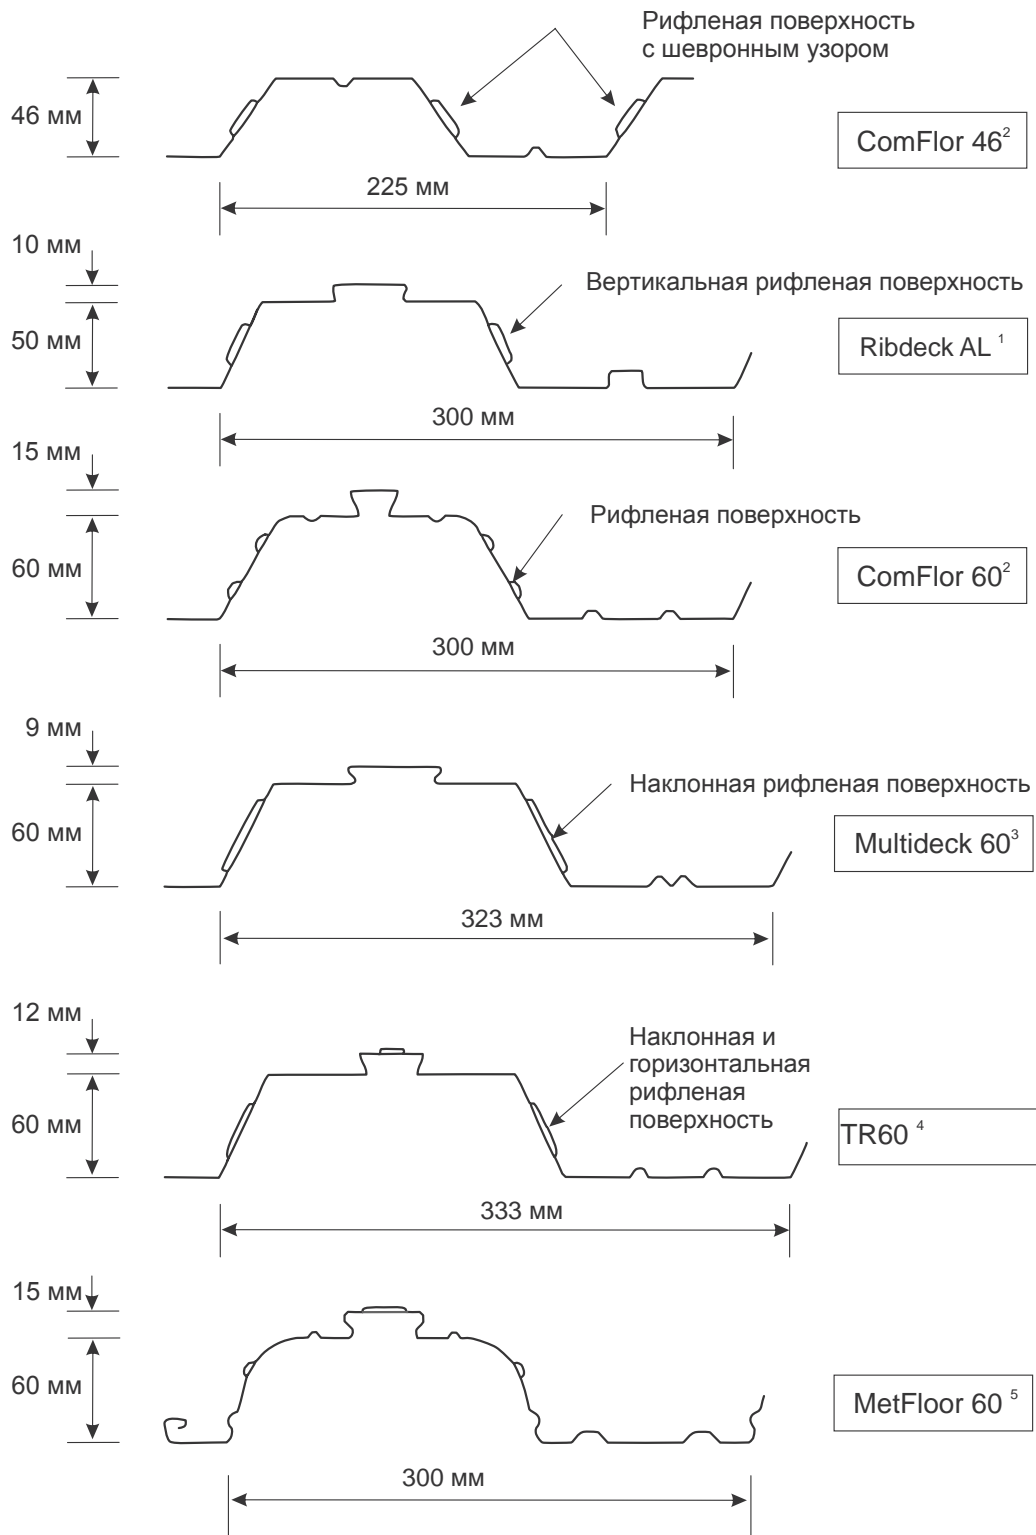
Примеры настила с трапециевидным профилем высотой до 60 мм (без учета верхнего элемента жесткости), применяемого с комбинированными перекрытиями, поставляются следующими производителями.
